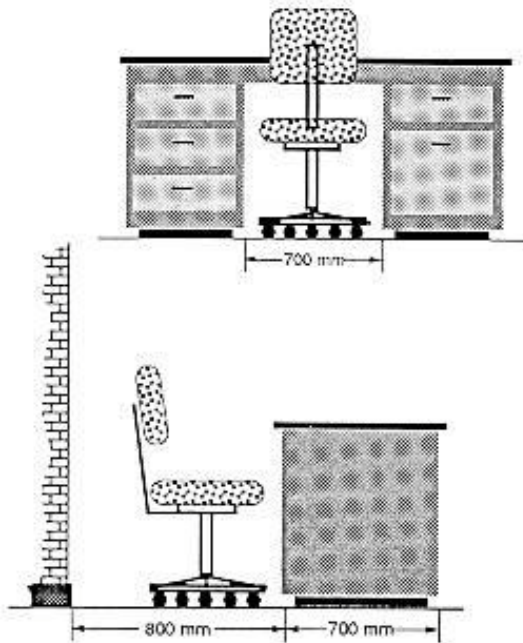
Cotas de emplazamiento para las piernas en puestos de trabajo sentado
